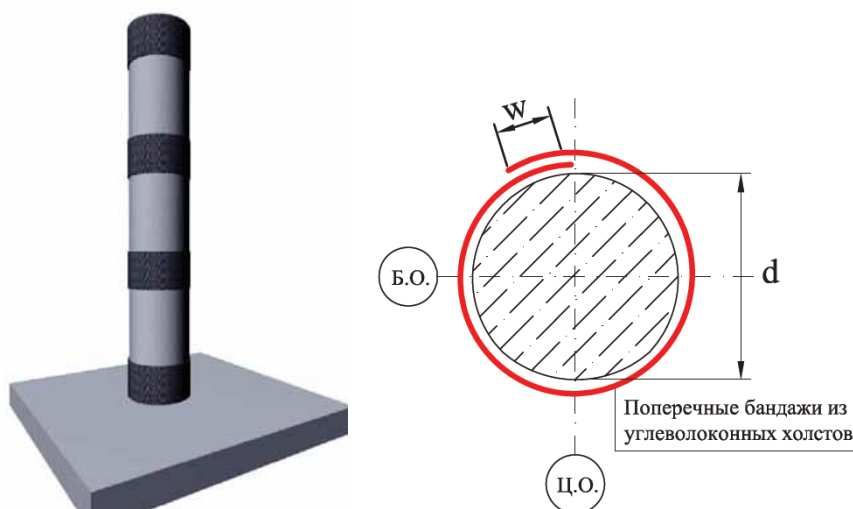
Схема усиления бандажными, поперечное сечение колонны:
